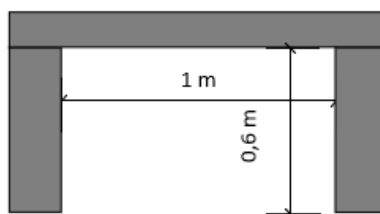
Underført faunapassage type B1 (våd), præfabrikeret elementer i beton.
